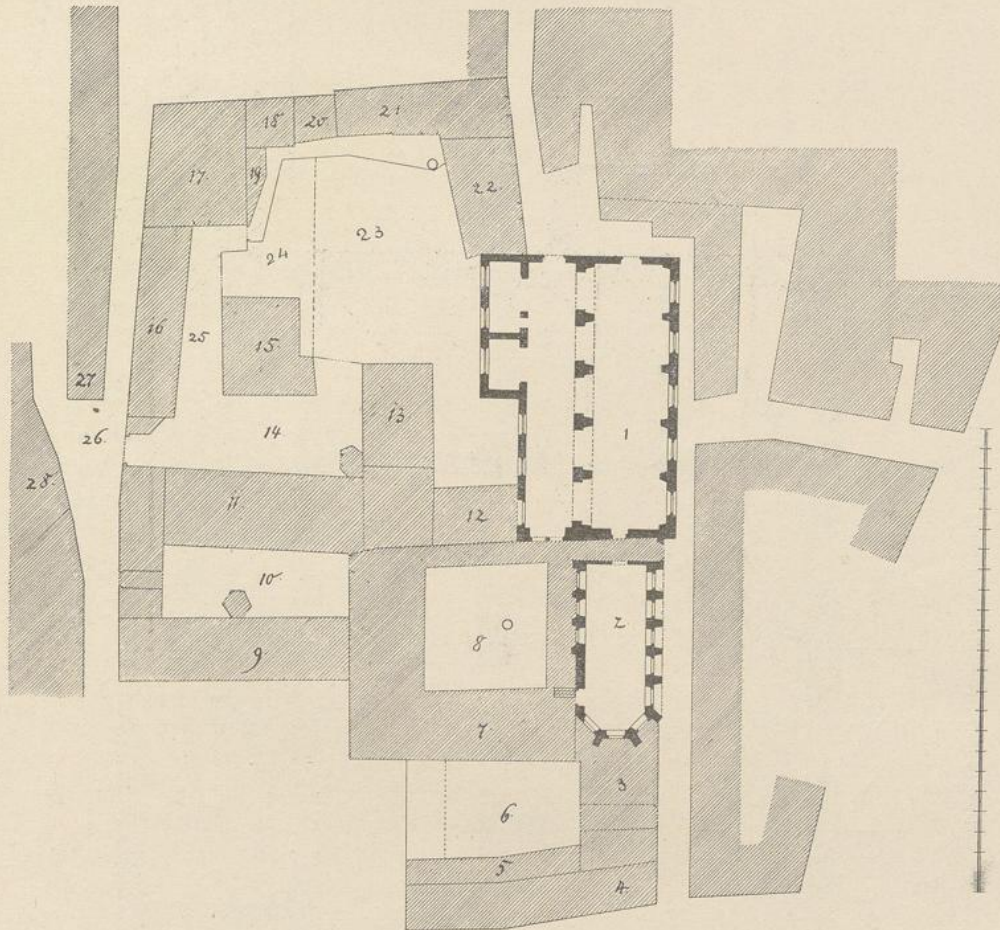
Ehemalige Barfüsser-Kirche; Lageplan.
